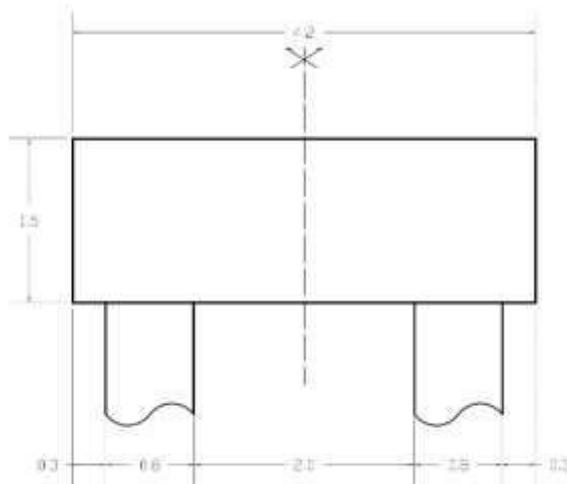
Sezione fondazione muro frangivento su cassa di colmata
